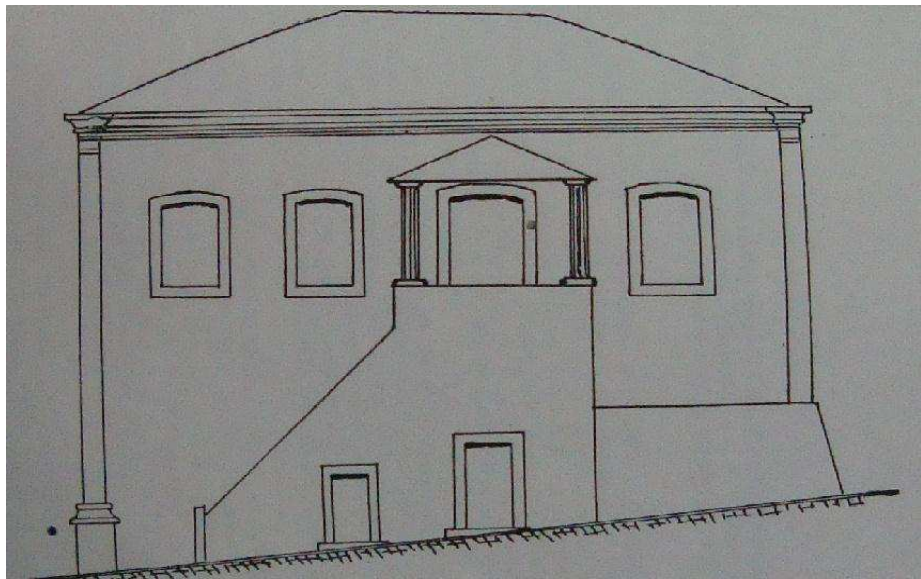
Planta do Prédio da Cadeia Pública – 1ª Parte
